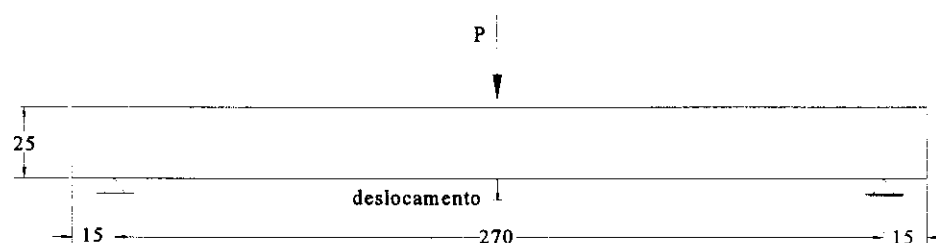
Geometria da viga ensaiada em BRAGUIM [09].
